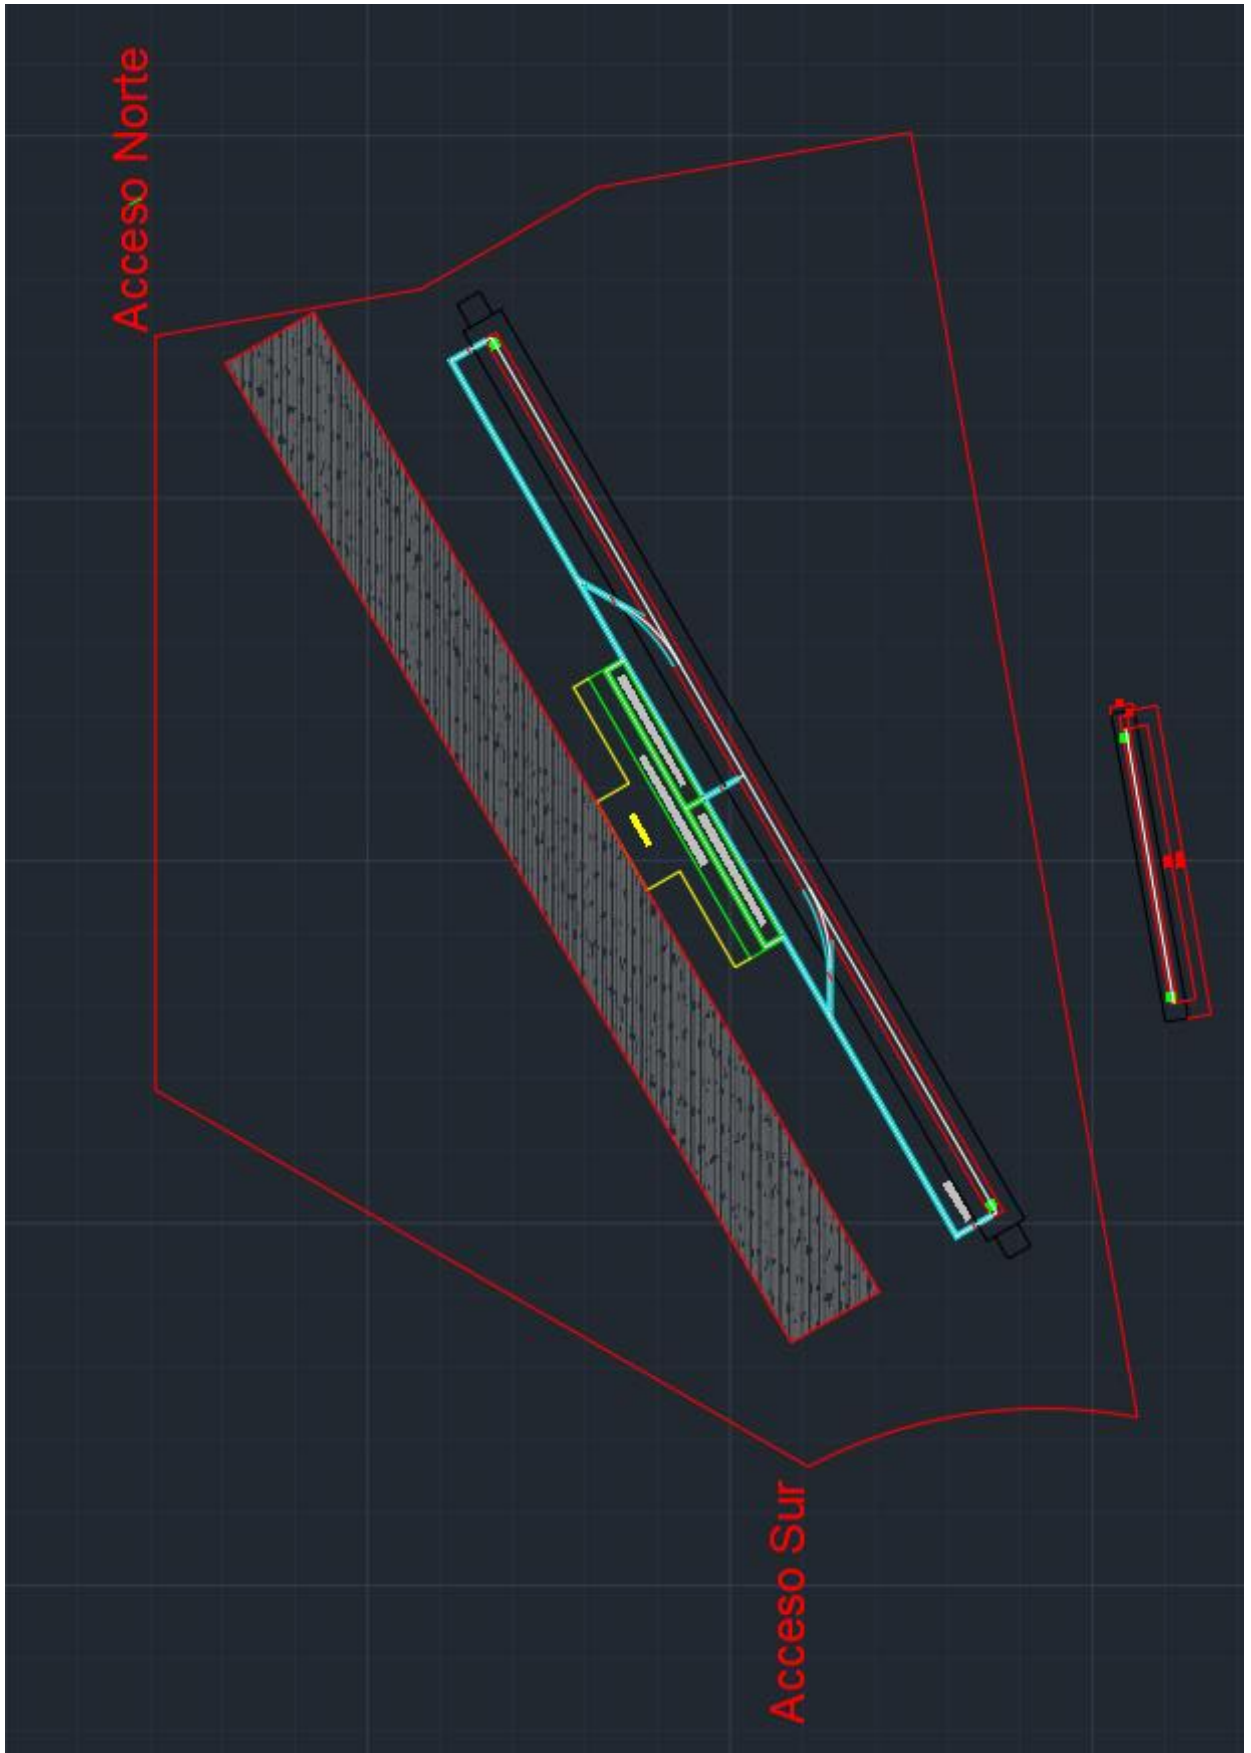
Planta de la infraestructura aeroportuaria propuesta en AutoCAD
